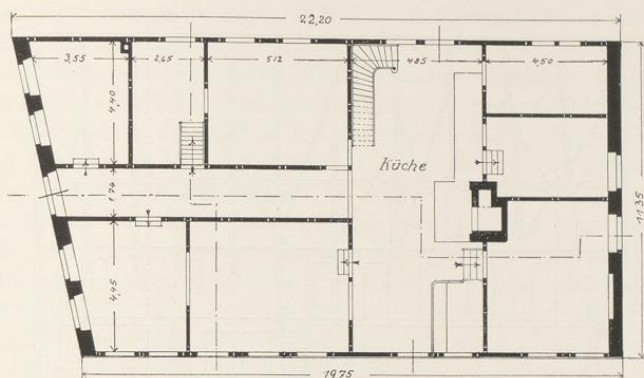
Grundriß des Erdgeschosses des Hauses Jüdefelderstraße 29
